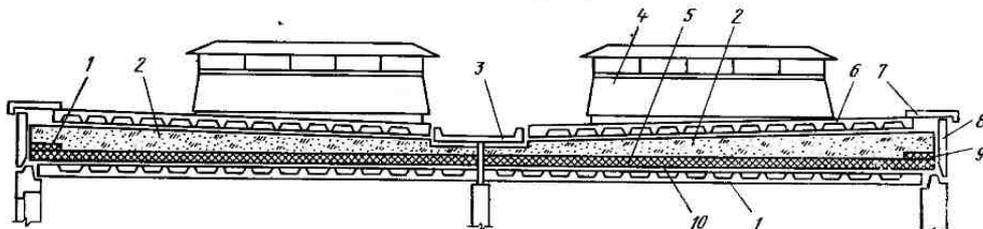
Вентилируемая совмещенная крыша из спаренных ребристых железобетонных плит:
